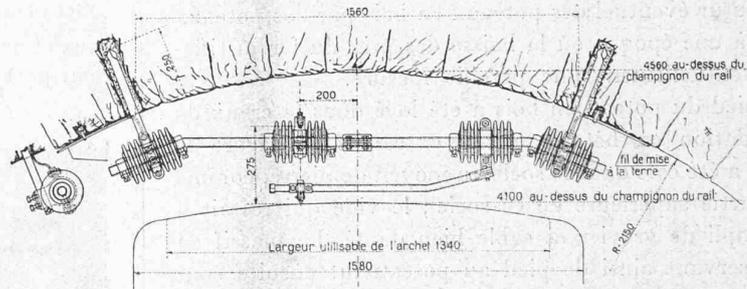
Point d'appui en tunnel en rampe. — 1 : 25.
